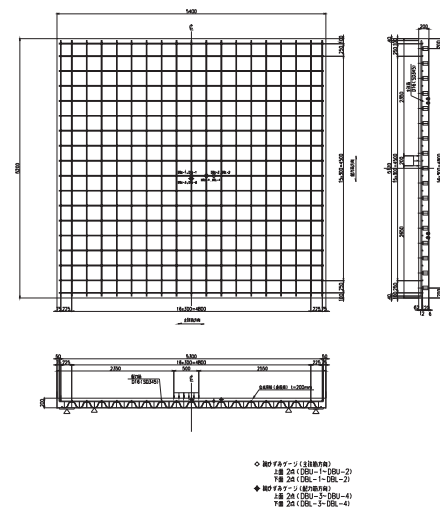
鋼ひずみゲージ取付位置 (鉄筋) (単位: mm)
